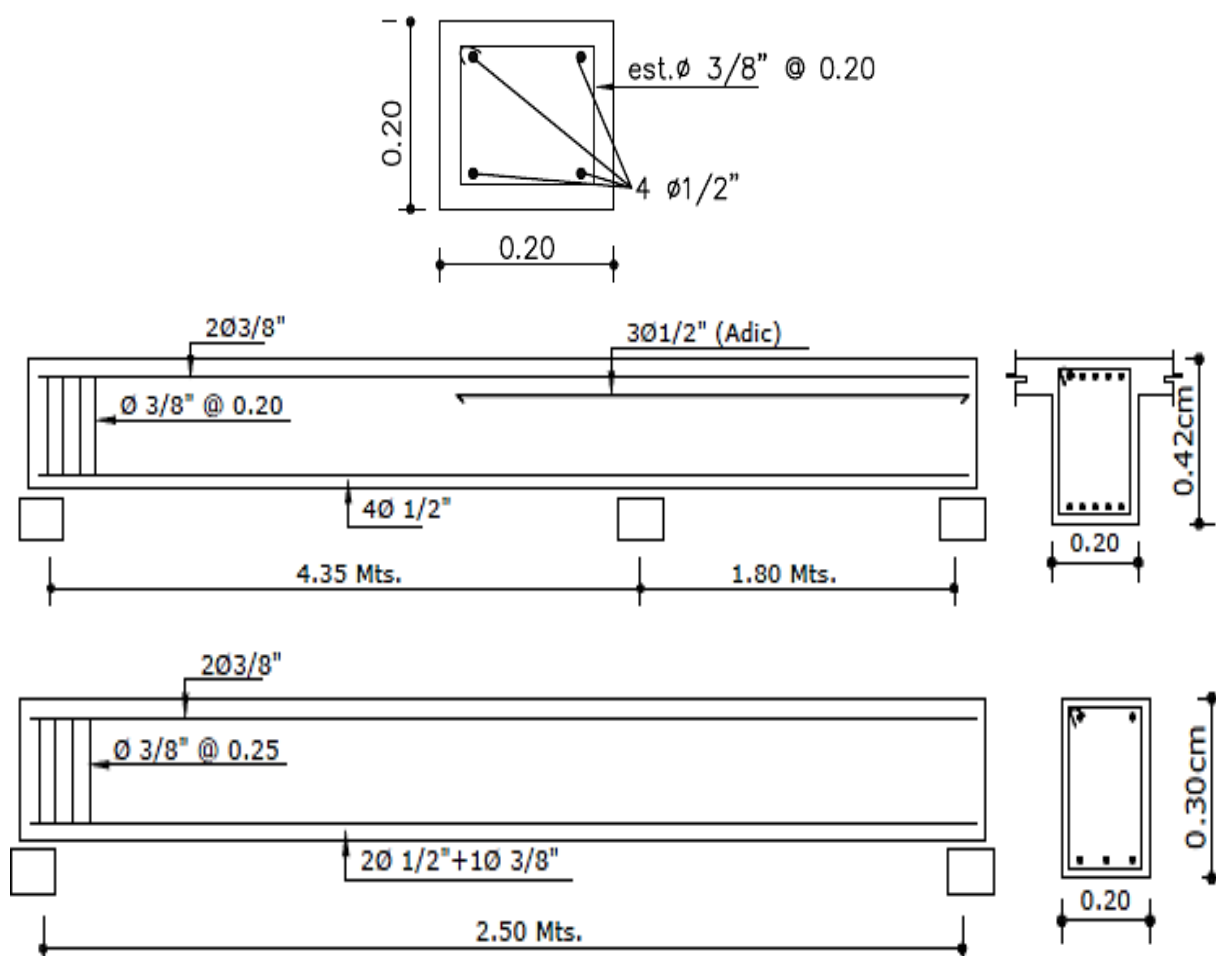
En orden descendente se coloca la sección de las columnas, el detalle longitudinal y transversal típico en vigas y el detalle longitudinal y transversal en dinteles.
